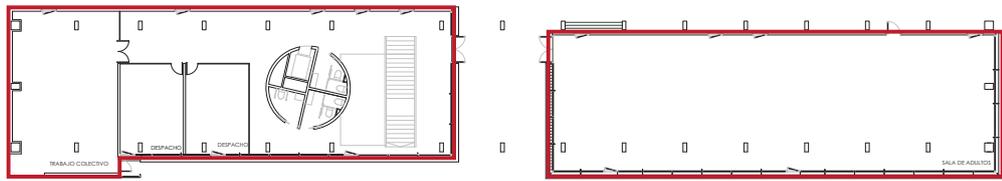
Planta baja. Elaboración propia a partir de documentación aportada por Fernando Sánchez Navarrete
